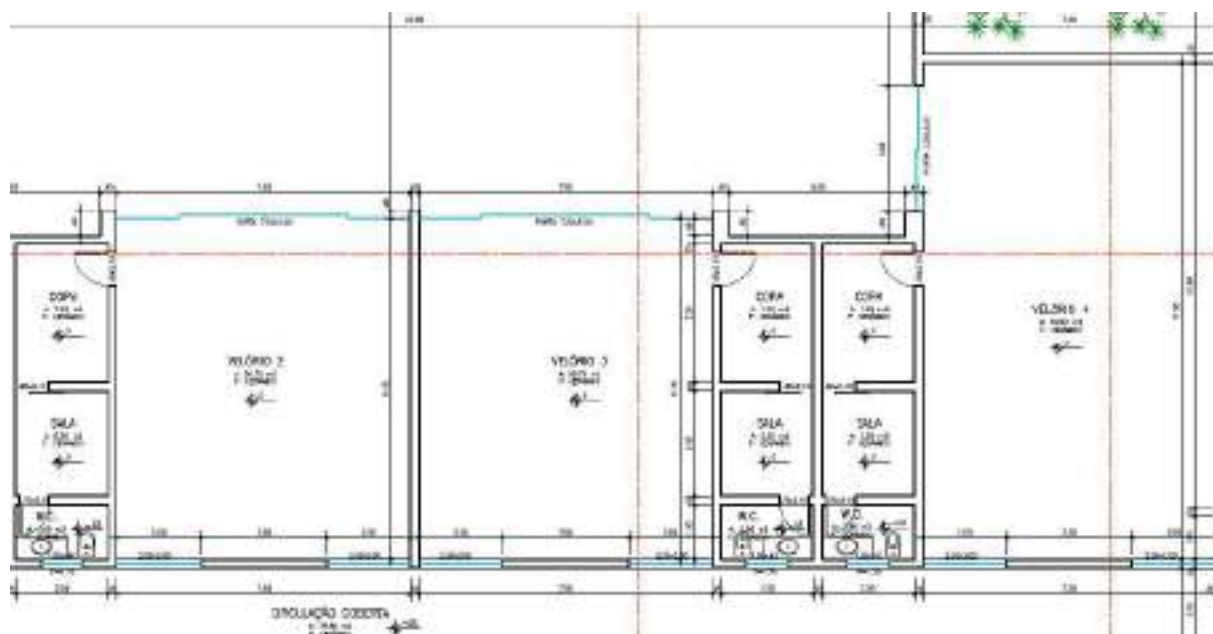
Partes da planta baixa geral da infraestrutura do velório.
